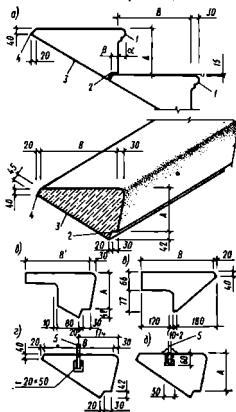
Конструкция ступеней мелкоэлементных лестниц:
